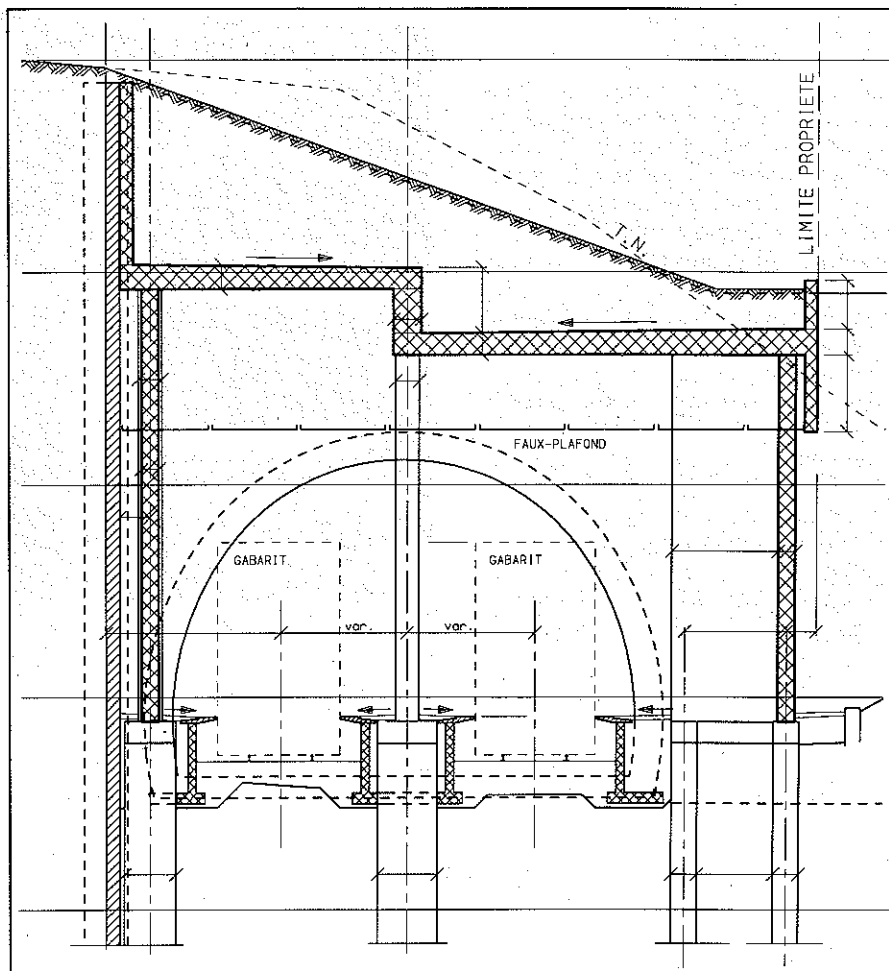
Station de Lausanne-Flon: coupe de la dalle de couverture en escalier.
